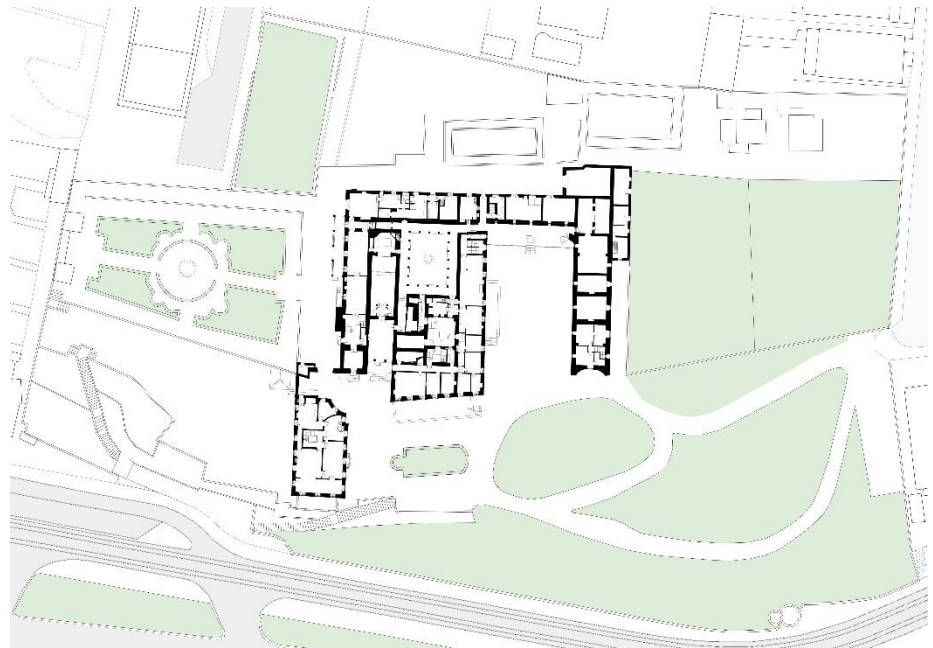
Planta do Primeiro Piso. Desenho do autor
